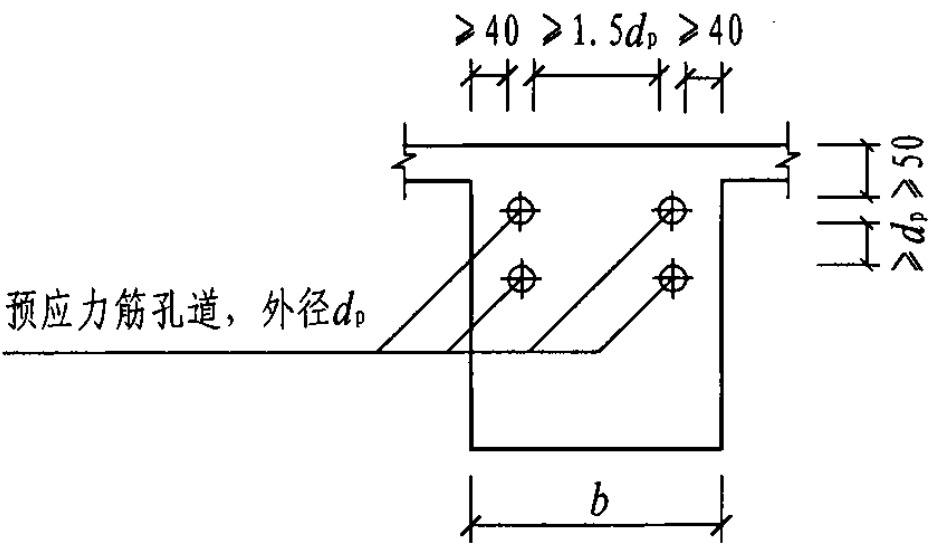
预应力筋孔道净距及混凝土保护层要求
